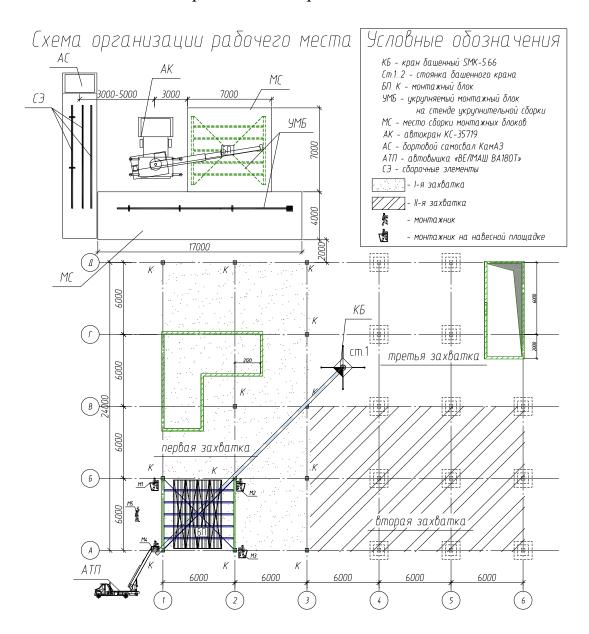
Схема организации рабочего места при монтаже плит БП (слева) и колонн К (справа)
